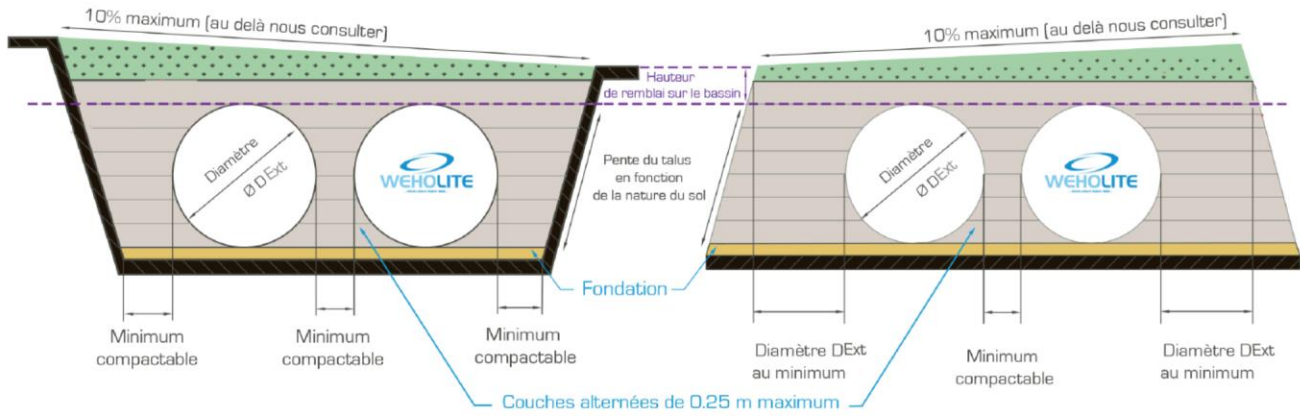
coupe de principe du bassin TUBAOTEC
